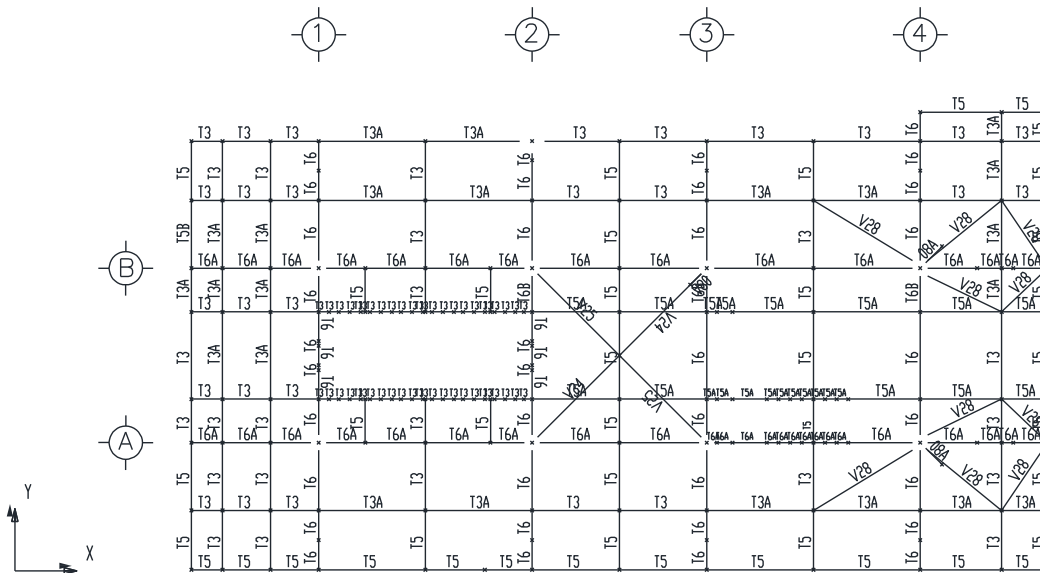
Grupos en Cubierta Principal Elev. (+) 19.100 m, superestructura
